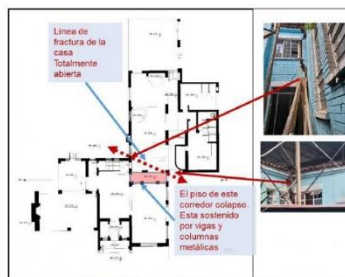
Ubicación de la fractura en planta. Fuente: Construcción propia consultor, sobre planos 2025.
